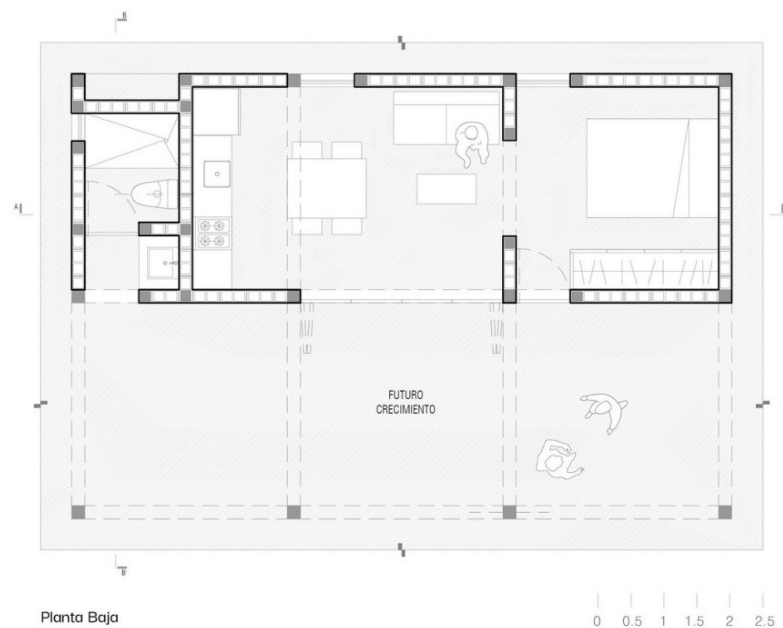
Planta y Estructura de Casa Progresiva rural.
